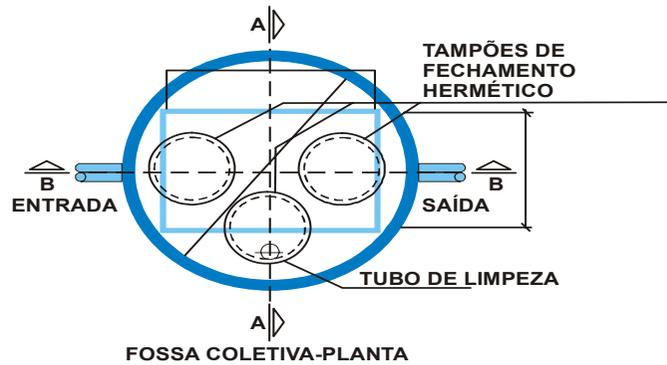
Planta baixa de sistema com tratamento coletivo (sem escala)
